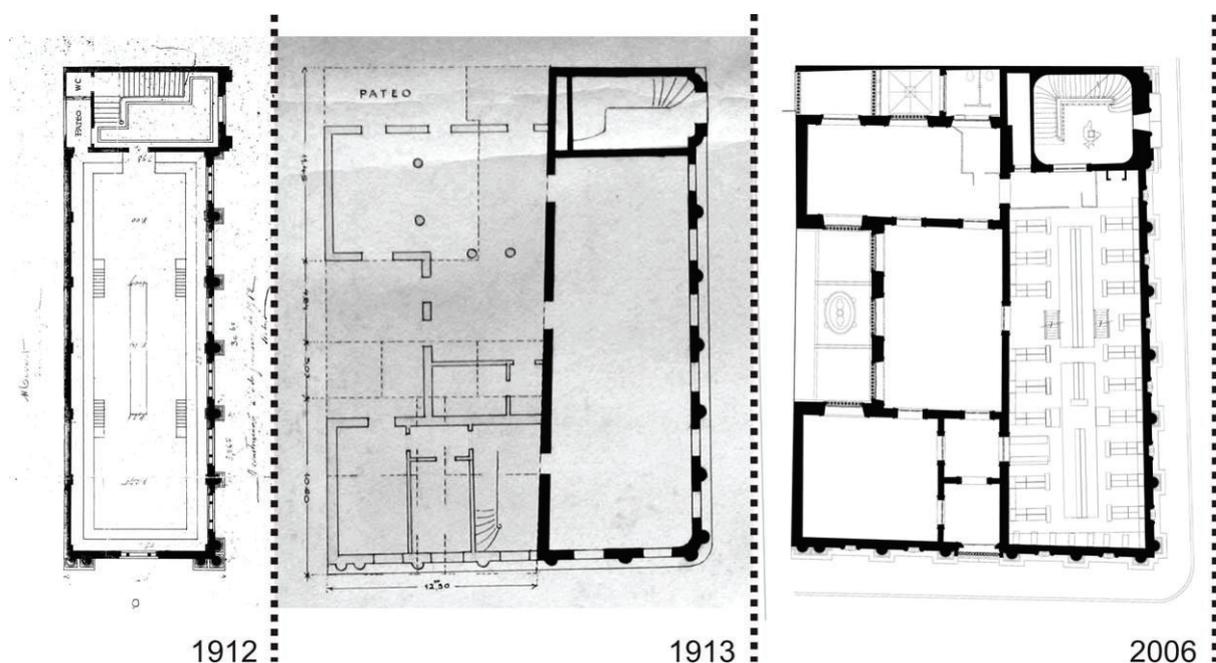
Fases de construção da Biblioteca Pública do Estado – planta segundo pavimento – 1912, 1913 e 2006. Fonte: Montagem da autora.
